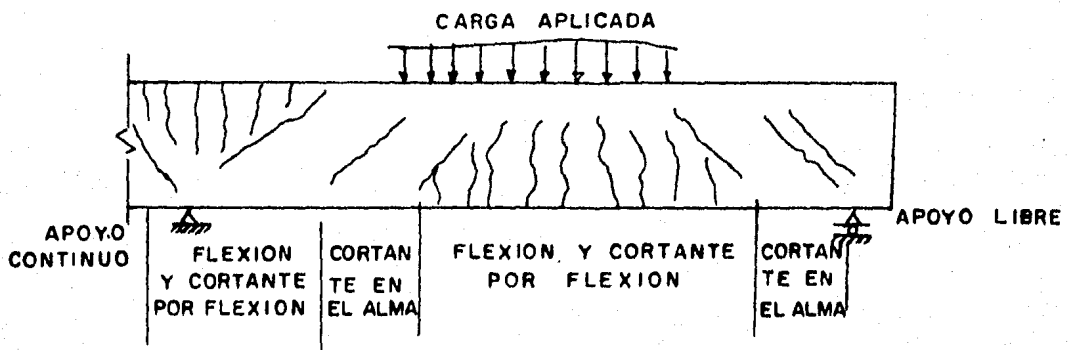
Tipos de agrietamiento en vigas de concreto.
